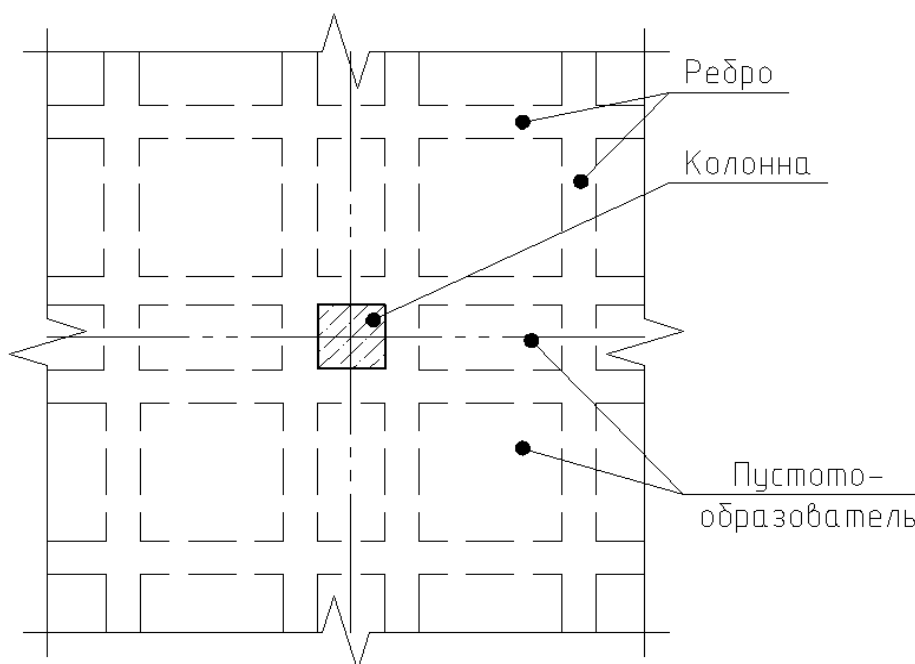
Расположение ребер кессонного перекрытия в районе колонны при реконструкции.
